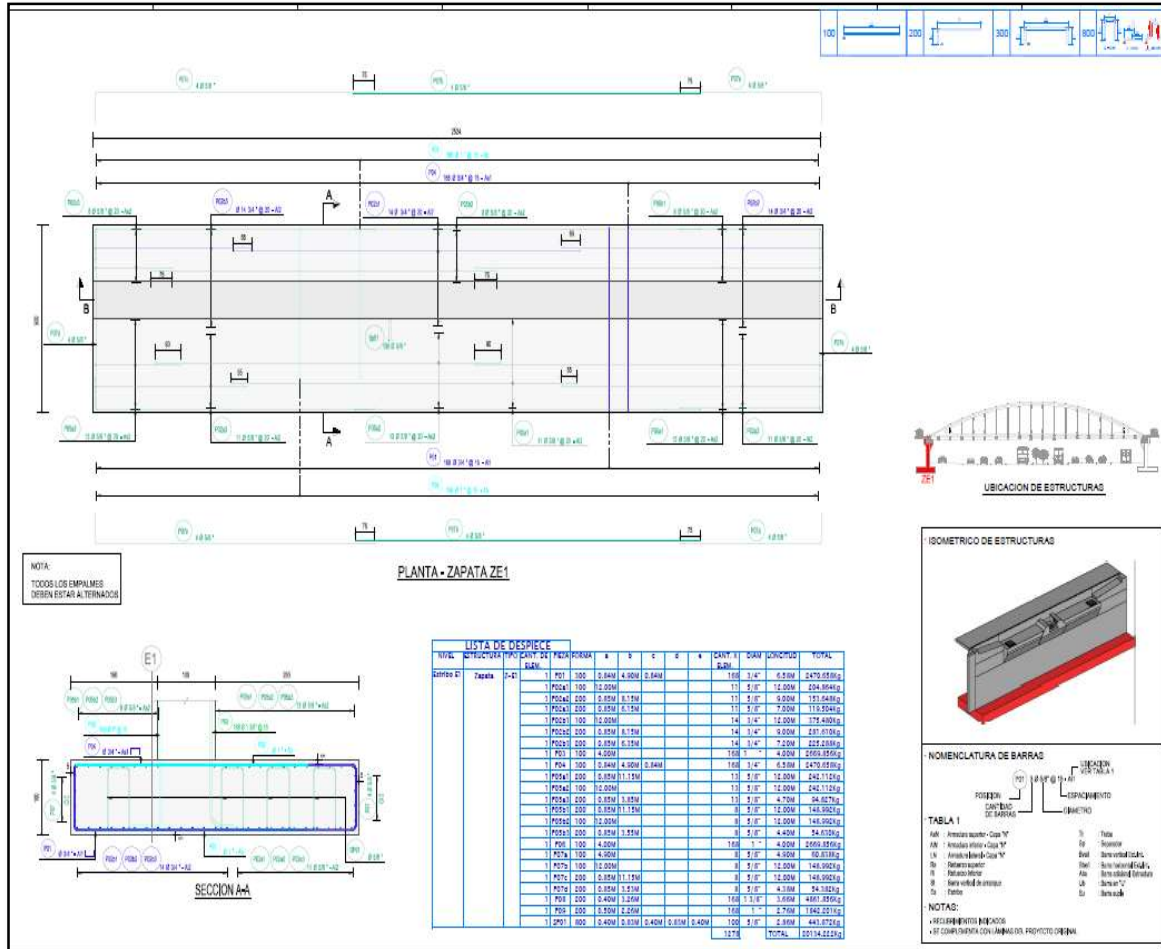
Plano de Instalación - Fuente: Aceros Arequipa
